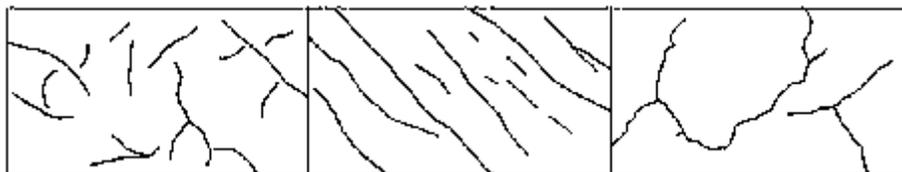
Patrones de fisuración de contracción plástica.
